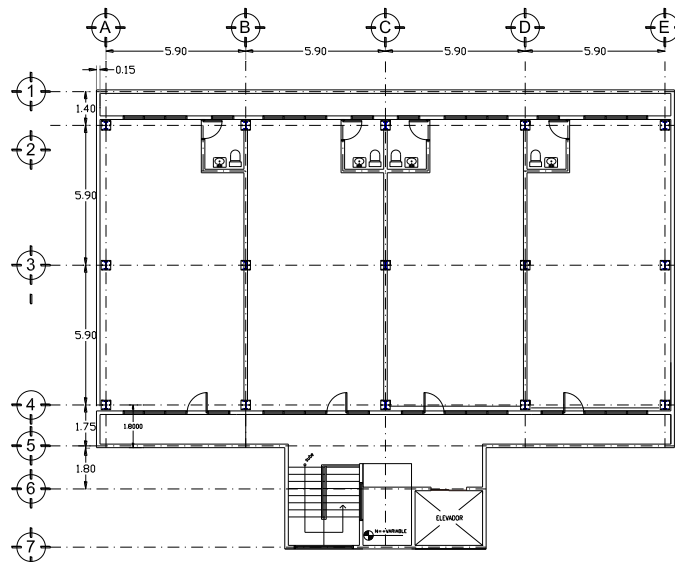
Planta Arquitectónica del Tercer al Octavo Nivel.
